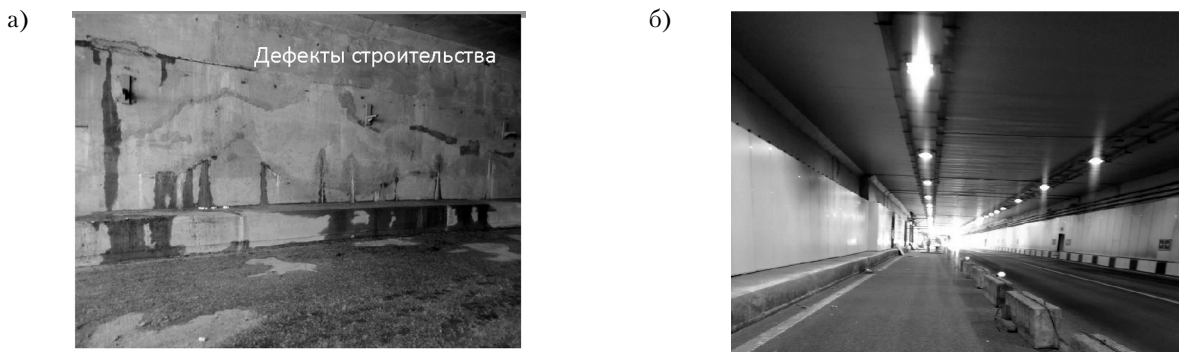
Алабяно-Балтийский тоннель: а) водопроявления в стенах и примыканиях; б) на этапе завершения работ после перерыва в строительстве
